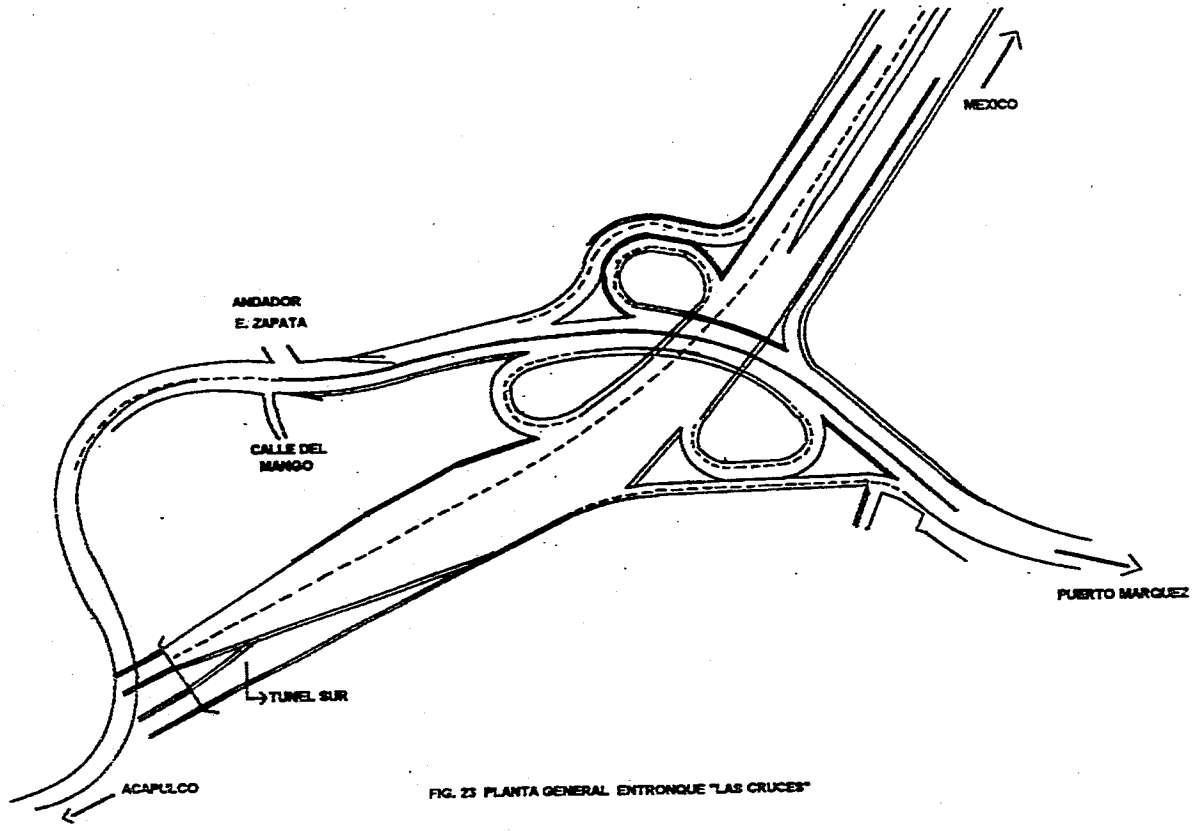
PLANTA GENERAL ENTRONQUE "LAS CRUCES"
